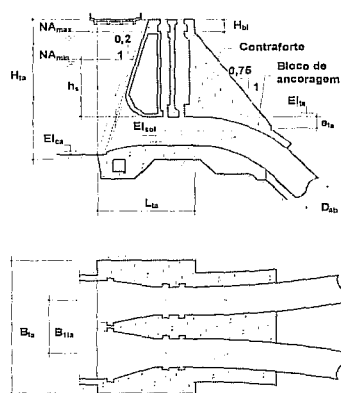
Seção típica e planta de tomada de água a gravidade
